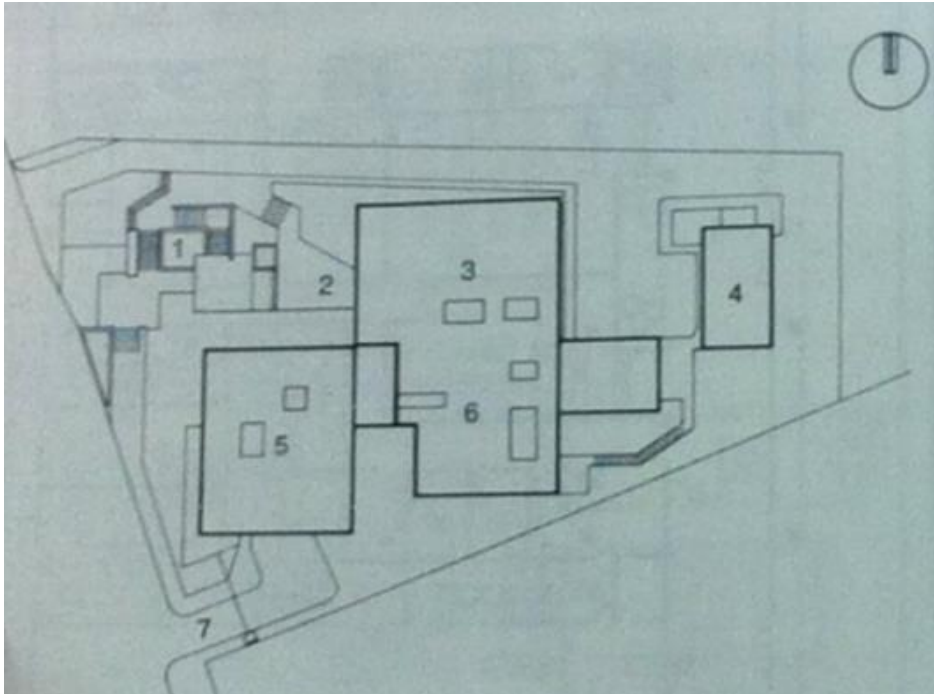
Planta Clínica Hospital ISSSTE Guanajuato. Fuente: Plazola Vol. 6
